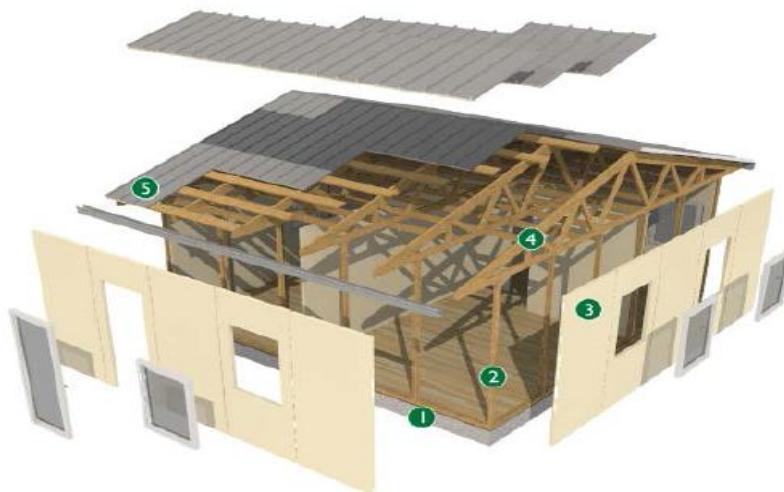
Fasi realizzative del sistema costruttivo Campiglio: 1- Fondazione in Calcestruzzo armato e posa della radice in legno; 2-Struttura portante verticale. Pilastrini e capriate reticolari in legno massiccio d'abete 3- Pannelli parete Campiglio; 4- Pannelli sandwich di copertura in lamiera d'acciaio e lattoneria; 5- finiture interne ed esterne e posa impianti.
